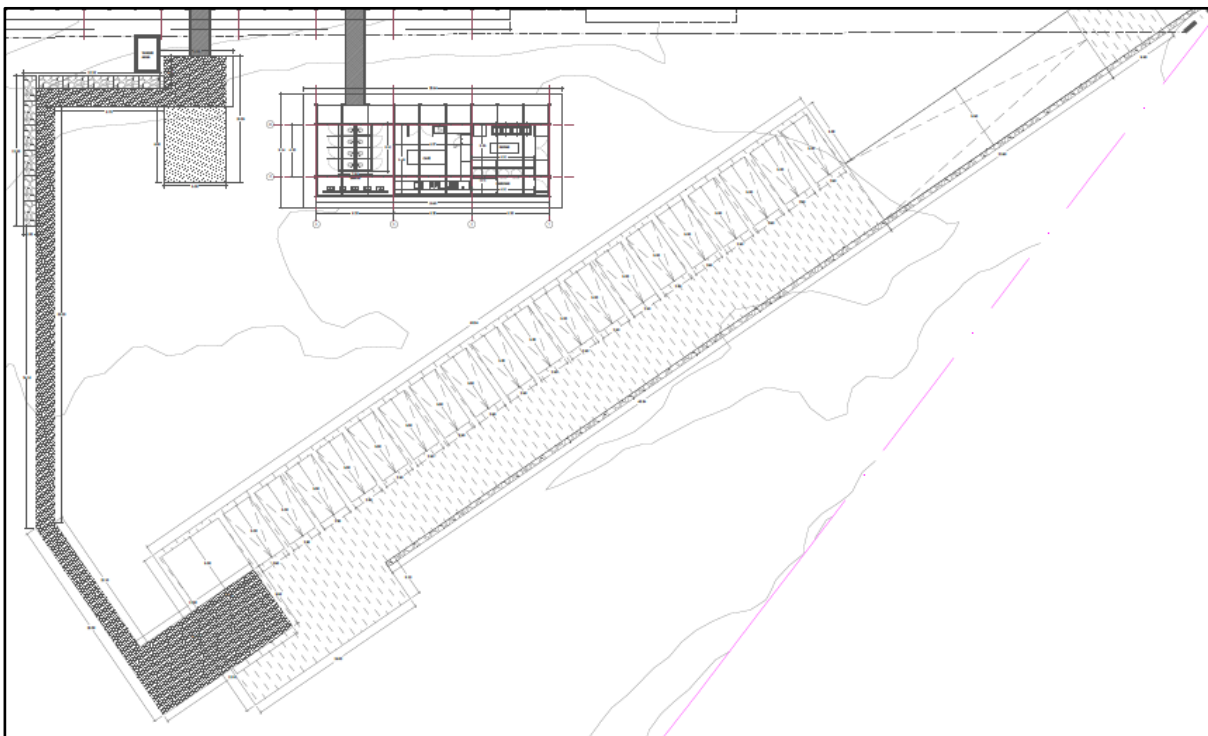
Vista de estacionamientos, acceso y pasillo.
